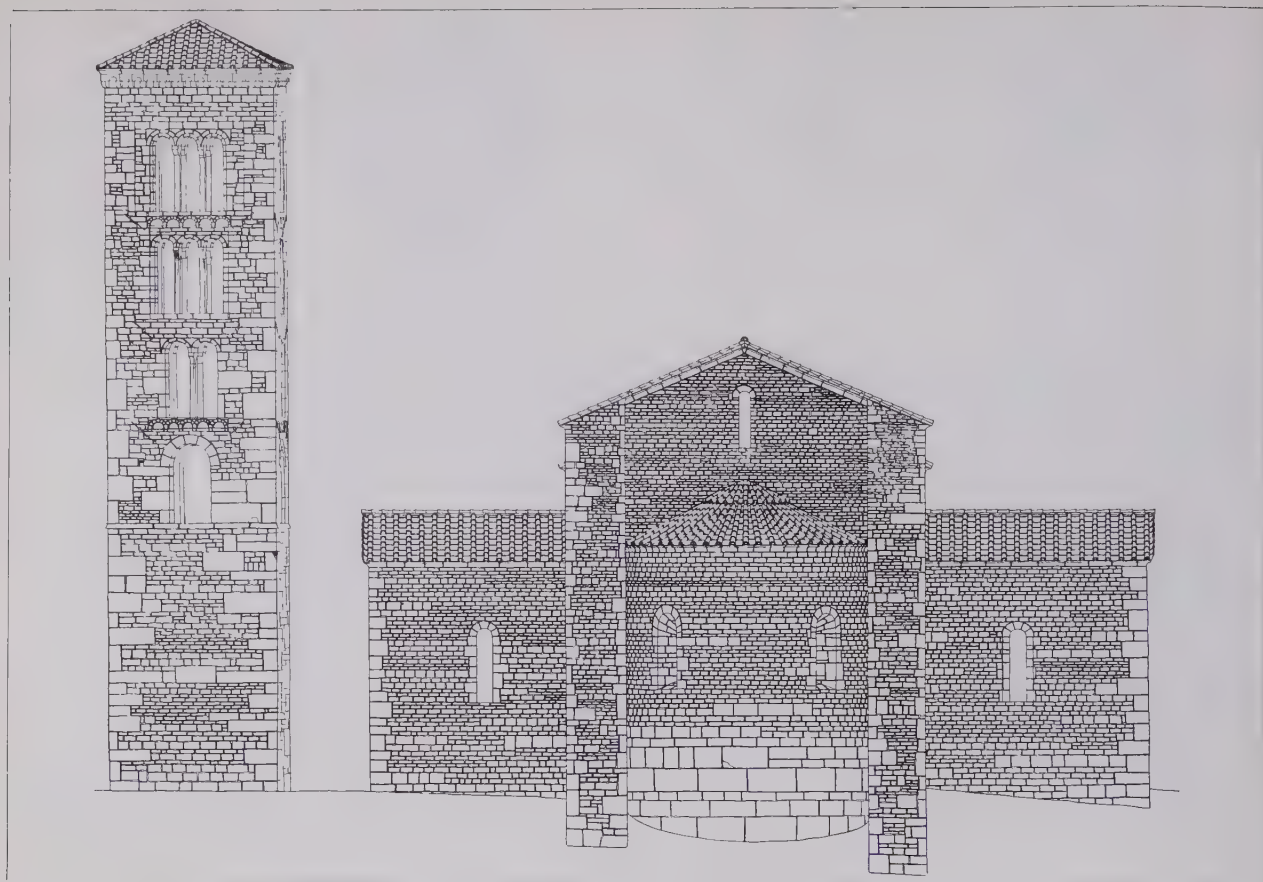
S. Maria del Piano in Orvinio - Prospetto posteriore. Scala 1:200
